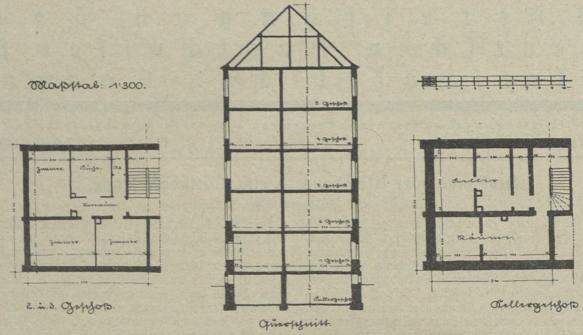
Schema des fünfgeschoffigen Großhauses.
